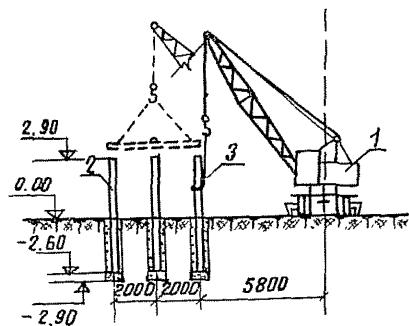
Разрез на стадии монтажа стоек и металлоконструкций опоры УО-110-105:
